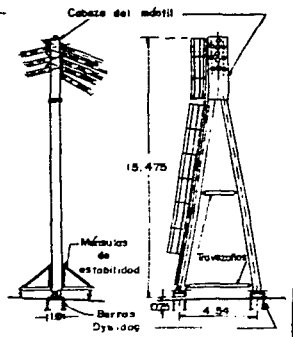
PRINCIPIO DE ATIRANTAMIENTO PROVISIONAL SOBRE PILA 7.
